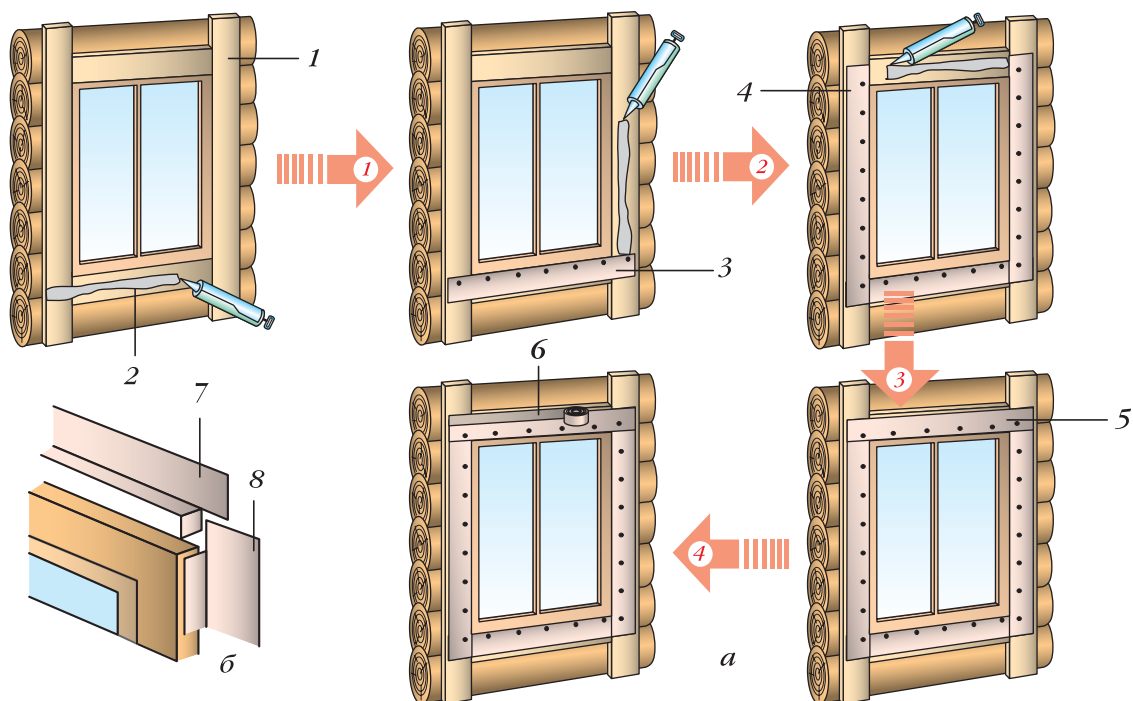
Гидроизоляция оконных и дверных проемов: а — заподлицо со стеной; б — выступающего из стены; 1 — обрешетка; 2 — силиконовый герметик; 3 — нижний фартук из кровельной жести; 4 — то же, боковой; 5 — то же, верхний; 6 — алюминиевый скотч; 7 — Г-образный фартук из кровельной жести; 8 — то же, боковой
